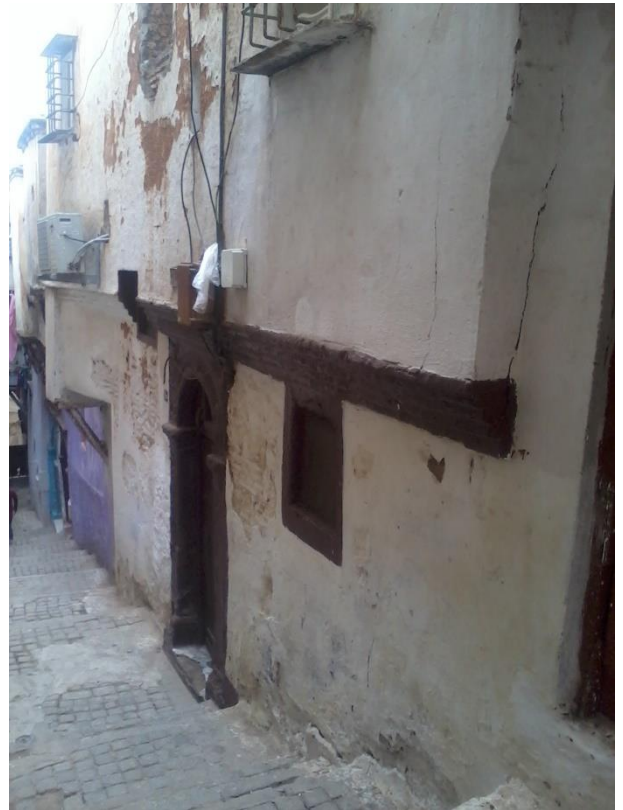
Photo de la Façade du cas d'étude (Auteur)
